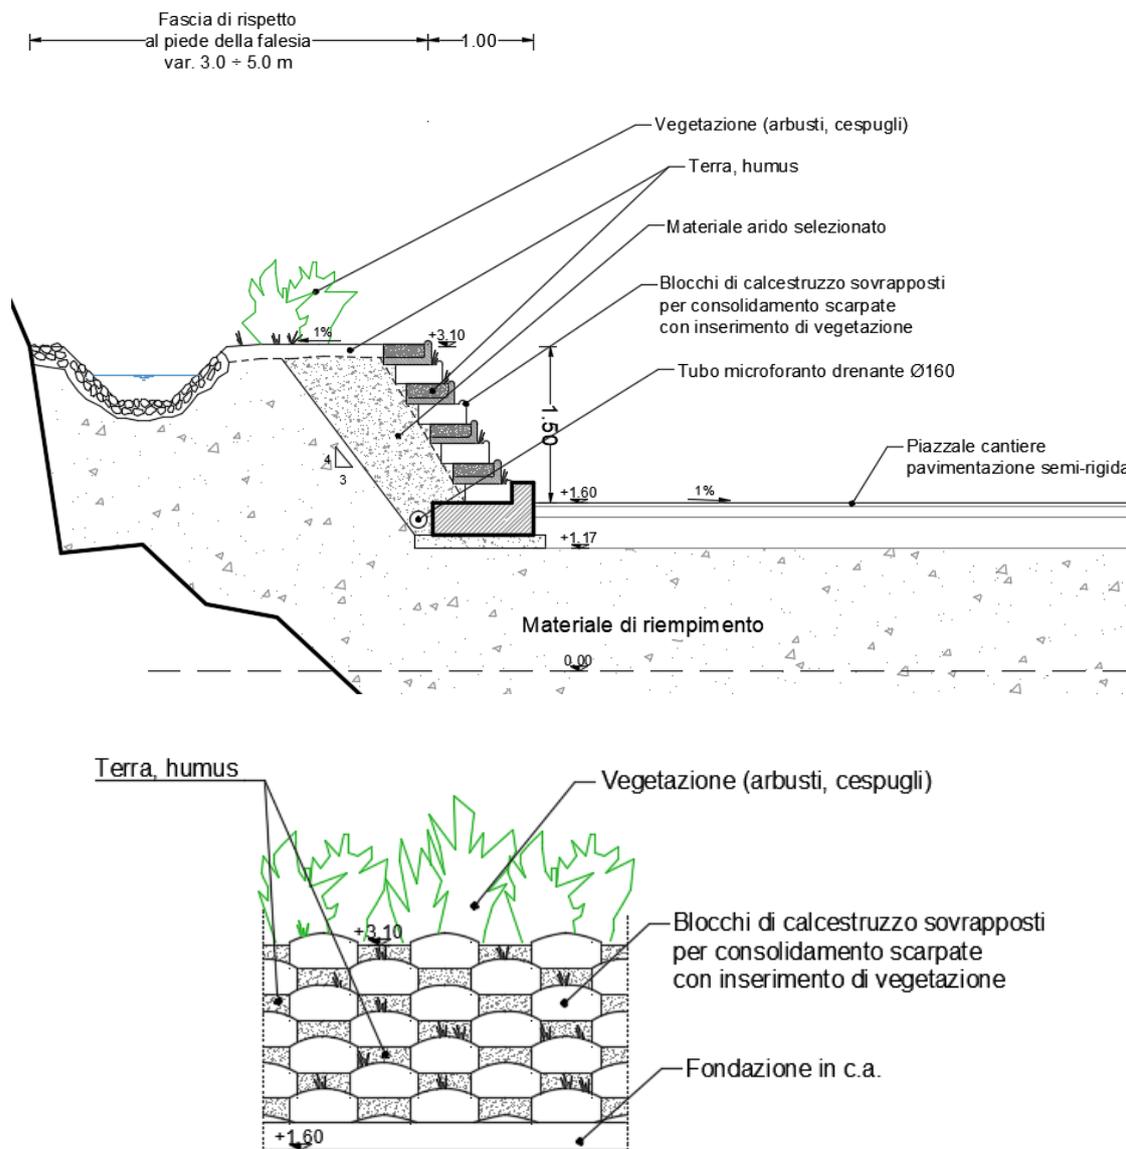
Sezione e vista frontale della protezione della scarpata del rilevato.
